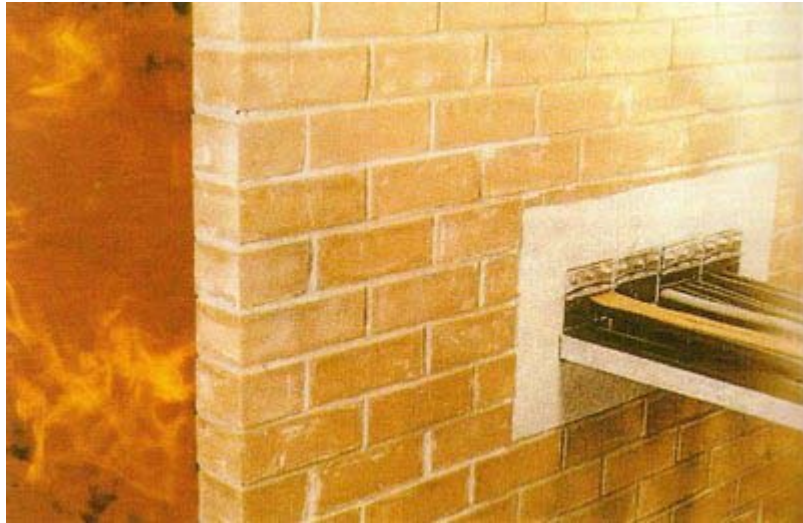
, muro de mampostería de arcilla con carga de fuego a una cara
